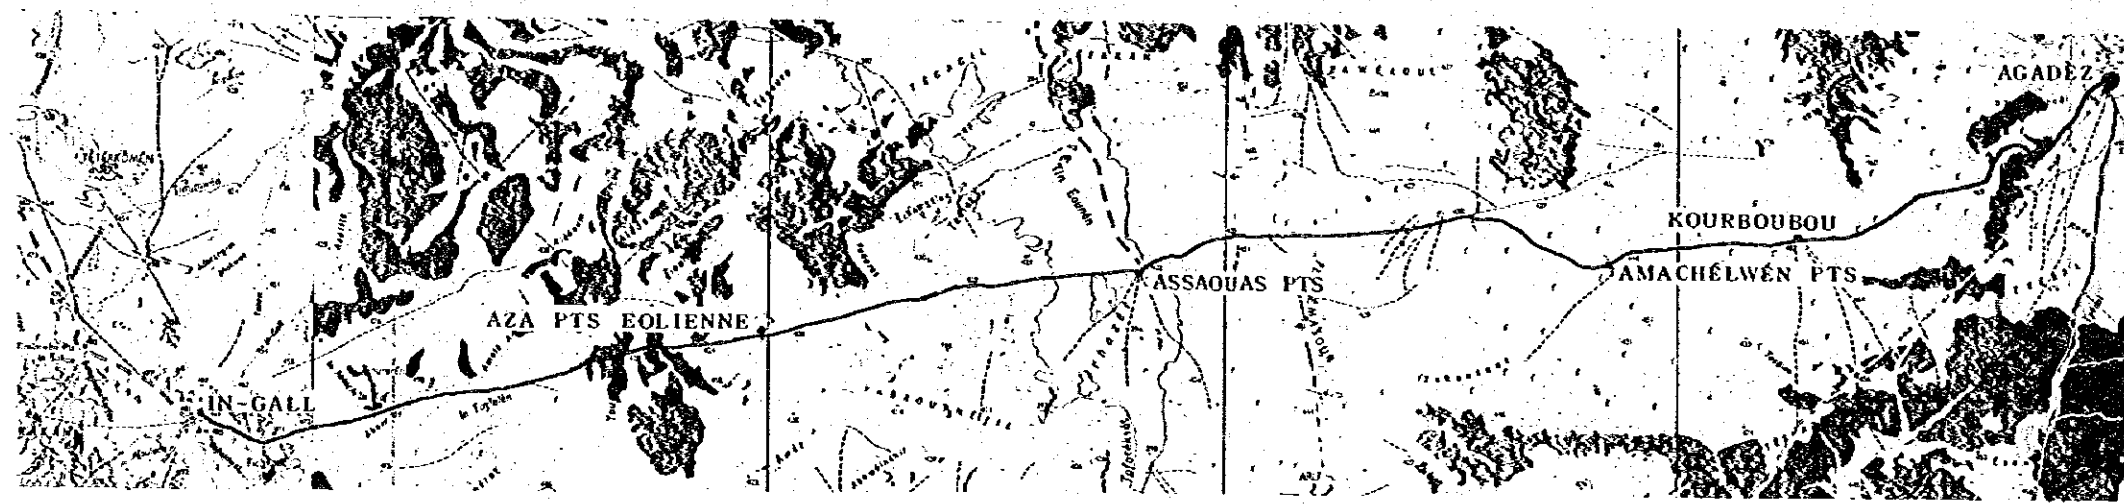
VUES EN PLAN ET EN COUPE (1/2)
